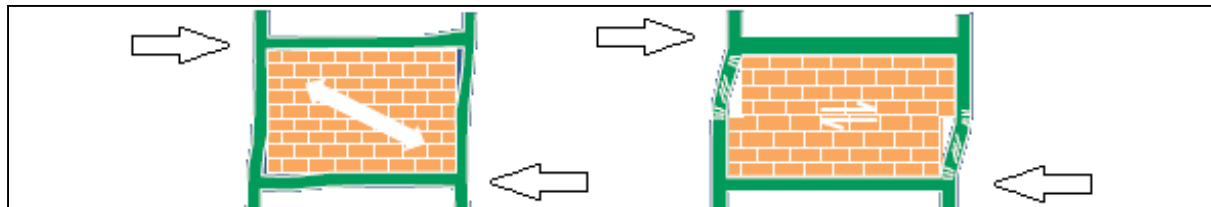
Ausfachung des Stahlbetonrahmens [7]
